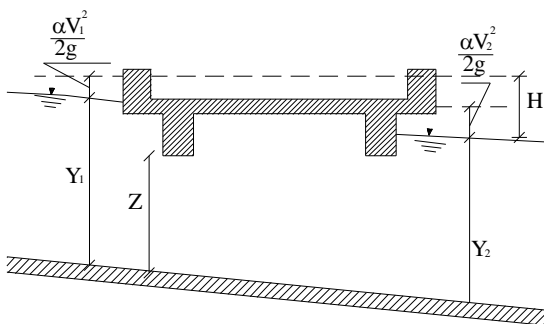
Sezione schematica di un ponte – Schema di calcolo
